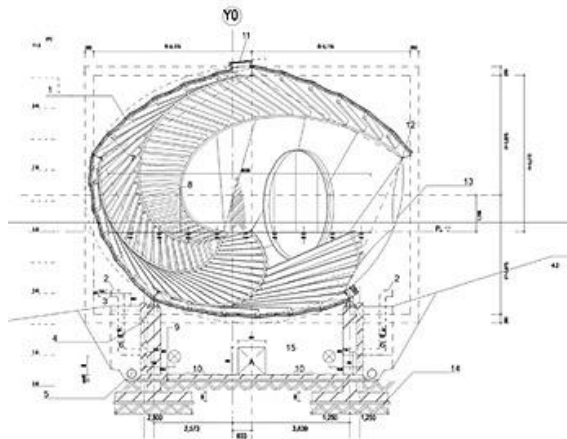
Plano de sección del Pabellón Torre Vieja. Arquitecto: Toyo Ito.
